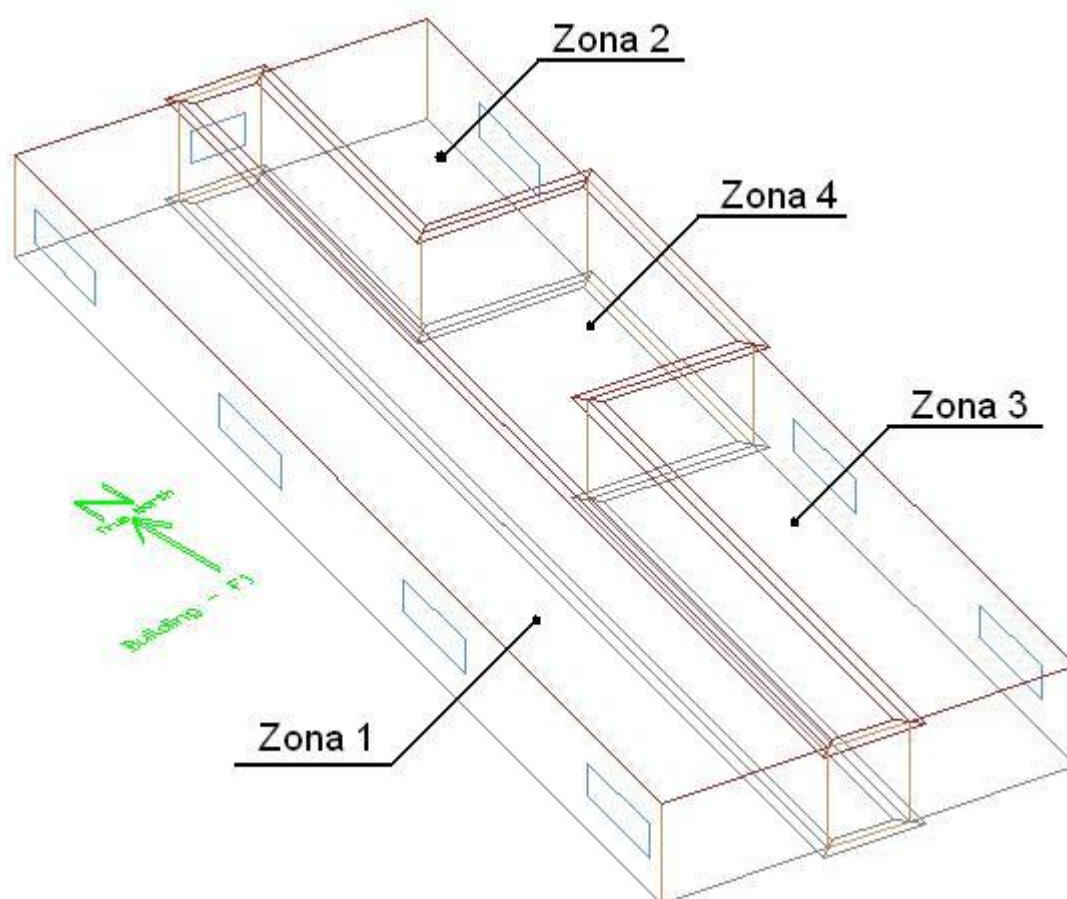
Vista isométrica do modelo do pavimento tipo usado nas simulações (MARIANA, 2008)
